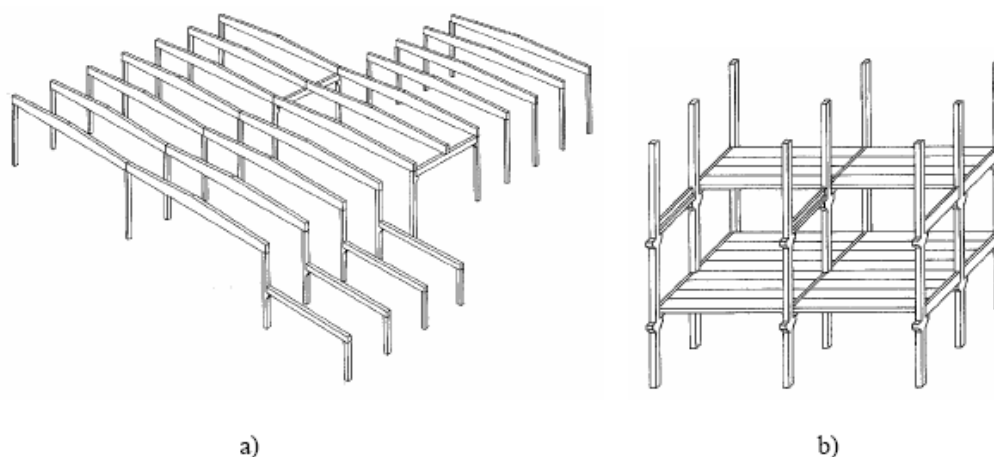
Sistemas pilar-viga, a) pilares e vigas de um único piso, b) pilares e vigas de vários andares (FIB, 2008)
